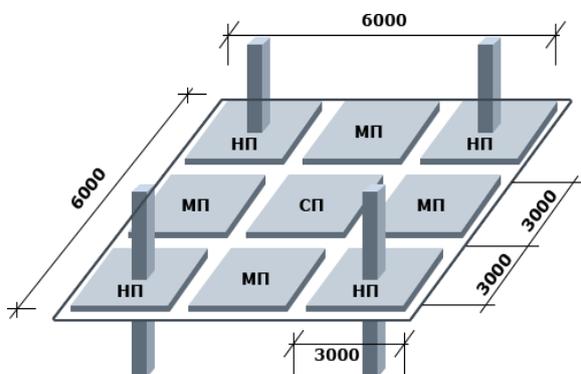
Схема безригельного каркаса КУБ-2.5
